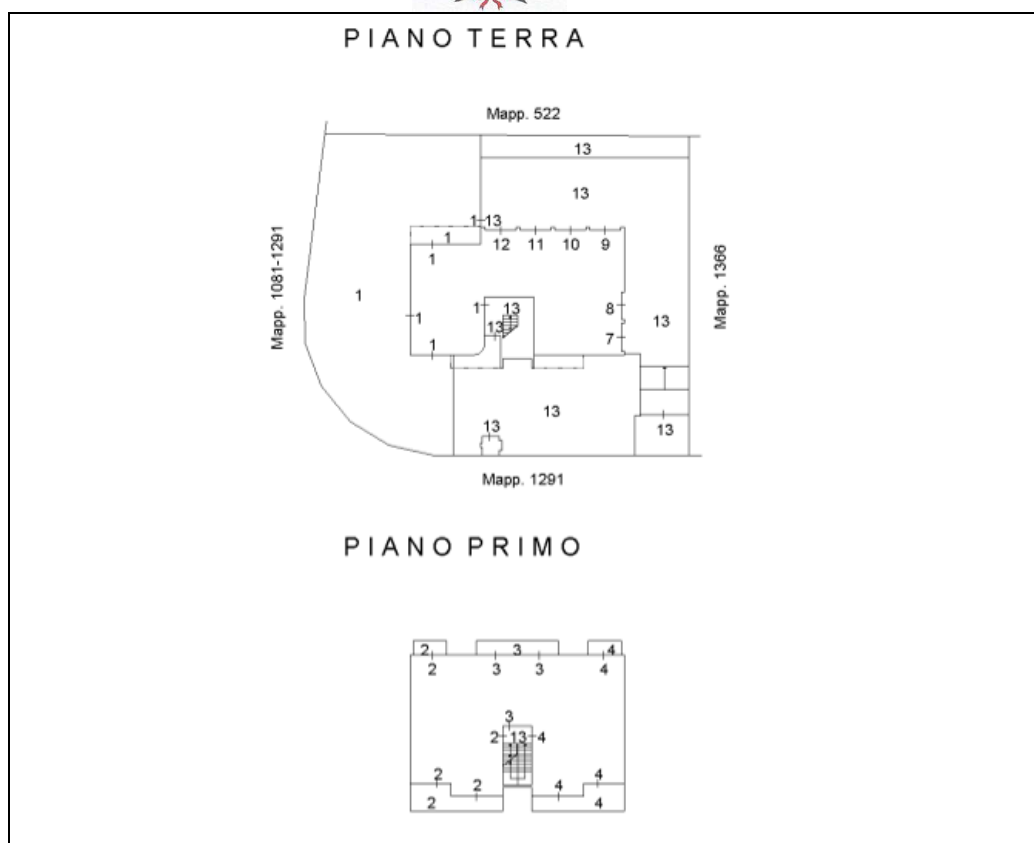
Elaborato planimetrico dimostrazione grafica subalterni
